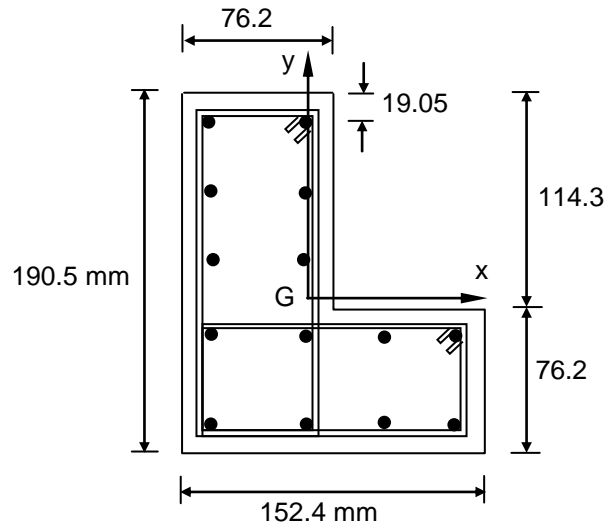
C5 betonarme kolon kesiti ([10,11])
